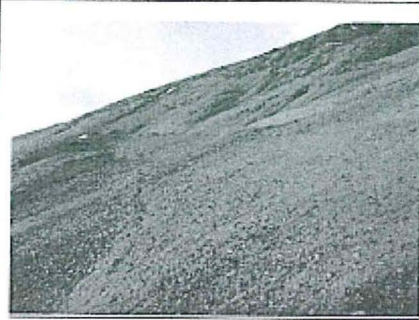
Vista Mirando hacia el Noroeste (perfilado actual).
